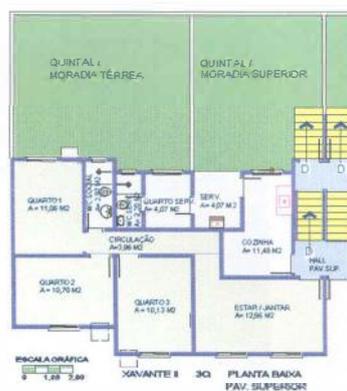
Xavante II. Planta baixa, pavimento superior - unidade de 3 quartos
